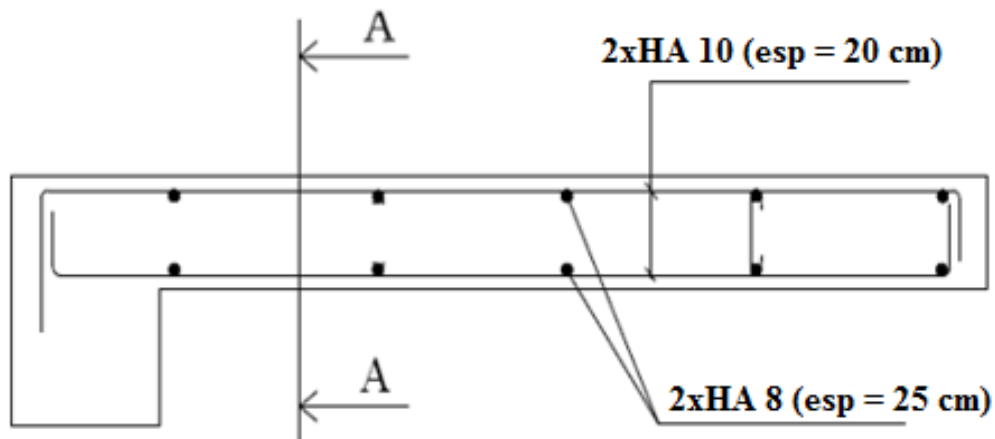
schéma de ferrailage du balcon COUPE A-A
